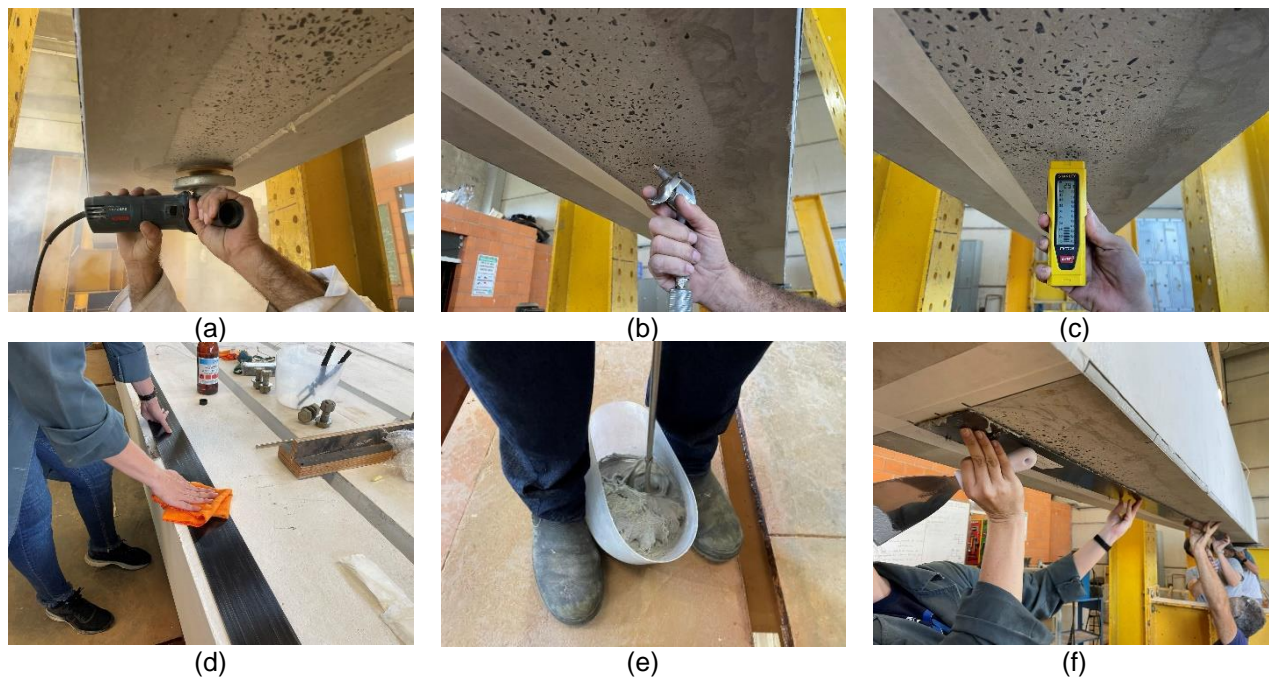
Aplicação do sistema de reforço com laminado de CFRP passivo segundo a técnica EBR (Autores)
